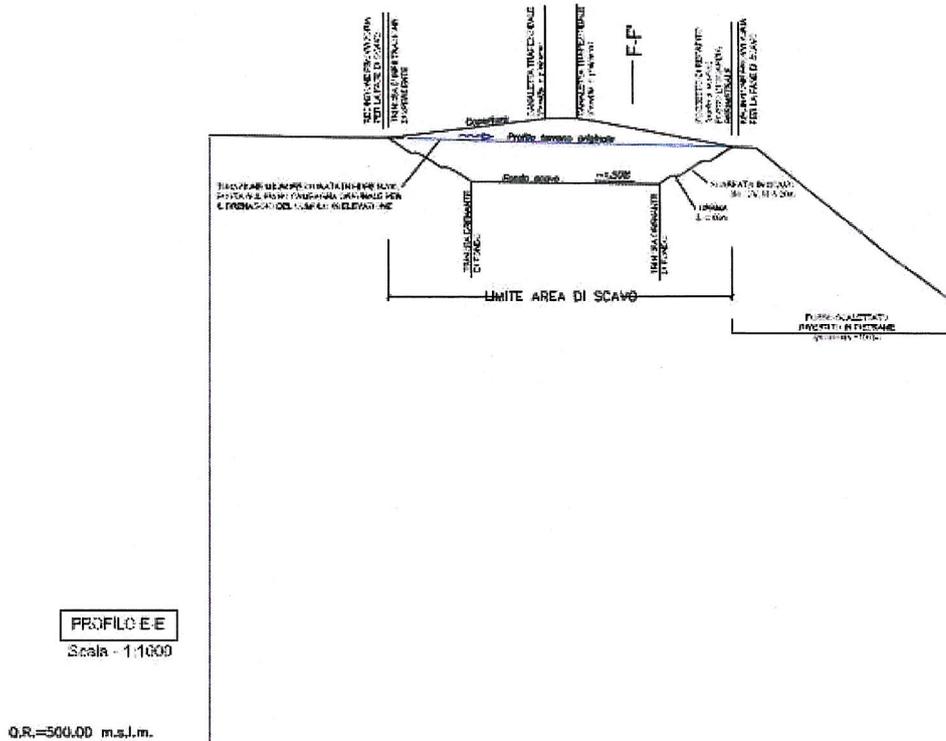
Depositi definitivi in Val Riga – C – Plattner – Sezione trasversale E-E
